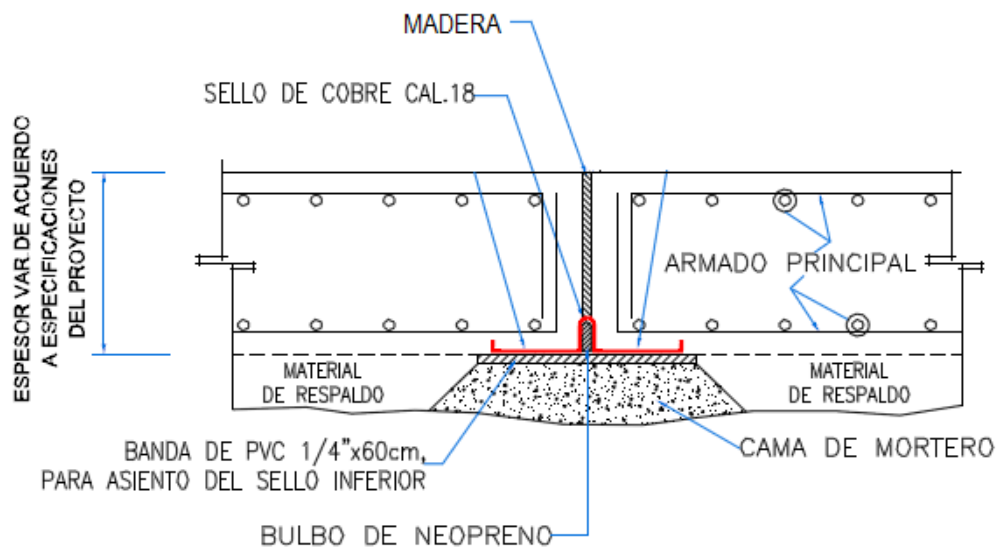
Junta de compresión de la C.H. El Cajón.
